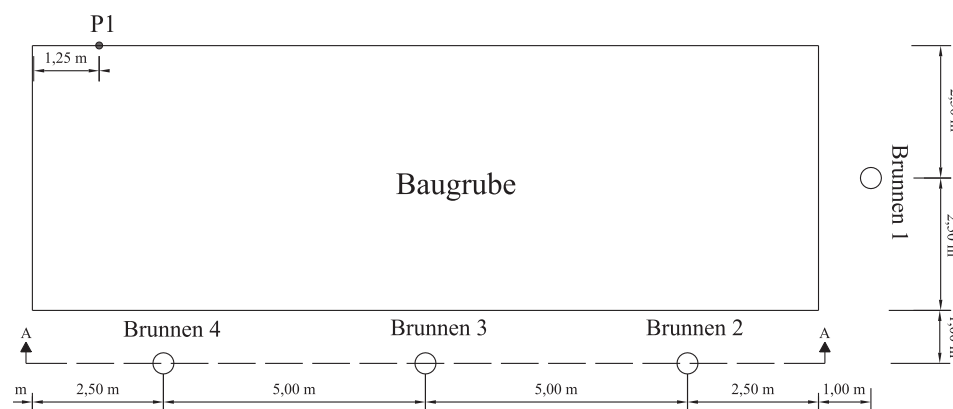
Grundriss der Baugrube mit Brunnenanordnung
